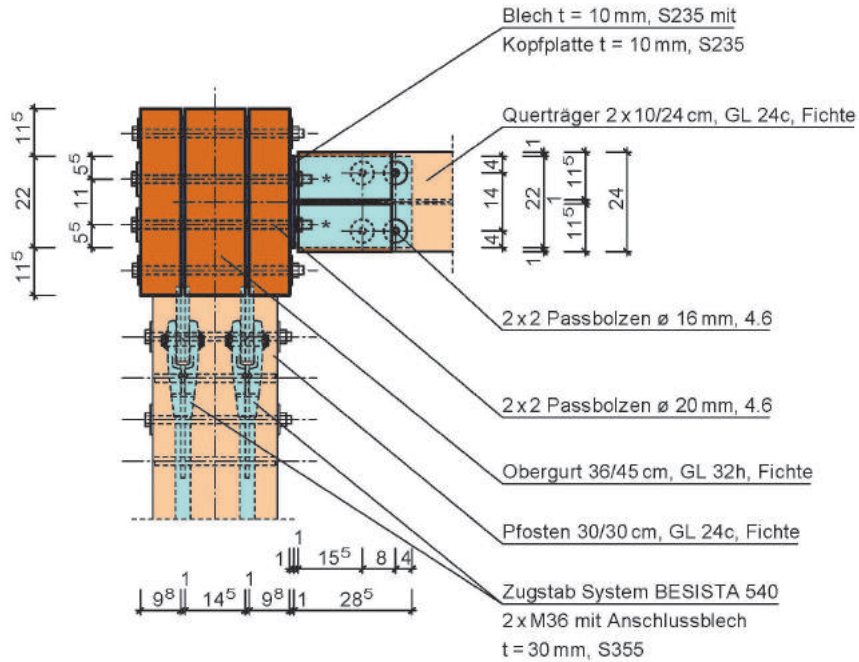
Geplanter Diagonalenanschluss mit eingeschlitzten Blechen und Stabdübeln sowie Passbolzen
